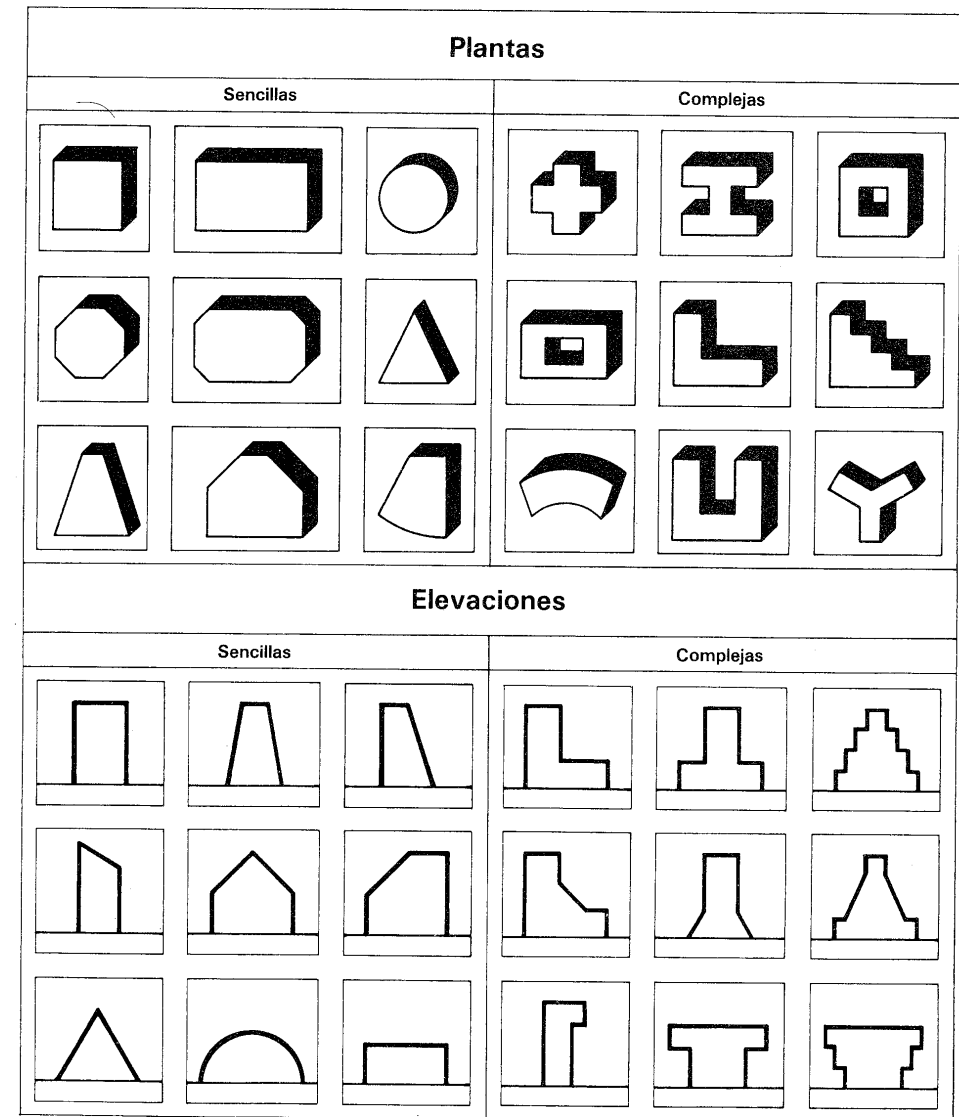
Formas sencillas y complejas en planta y elevación.
